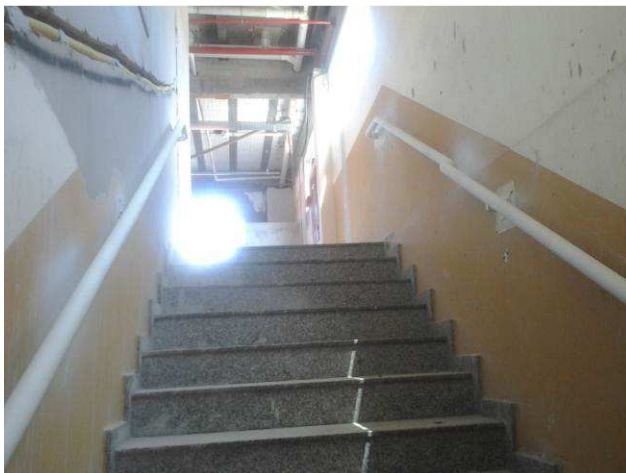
C: Corrimão instalado na escada de acesso ao primeiro pavimento
